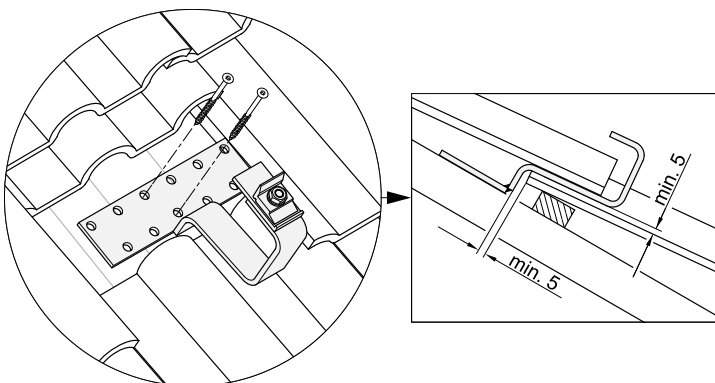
Korrekte Befestigung des Dachankers Typ P Stv
